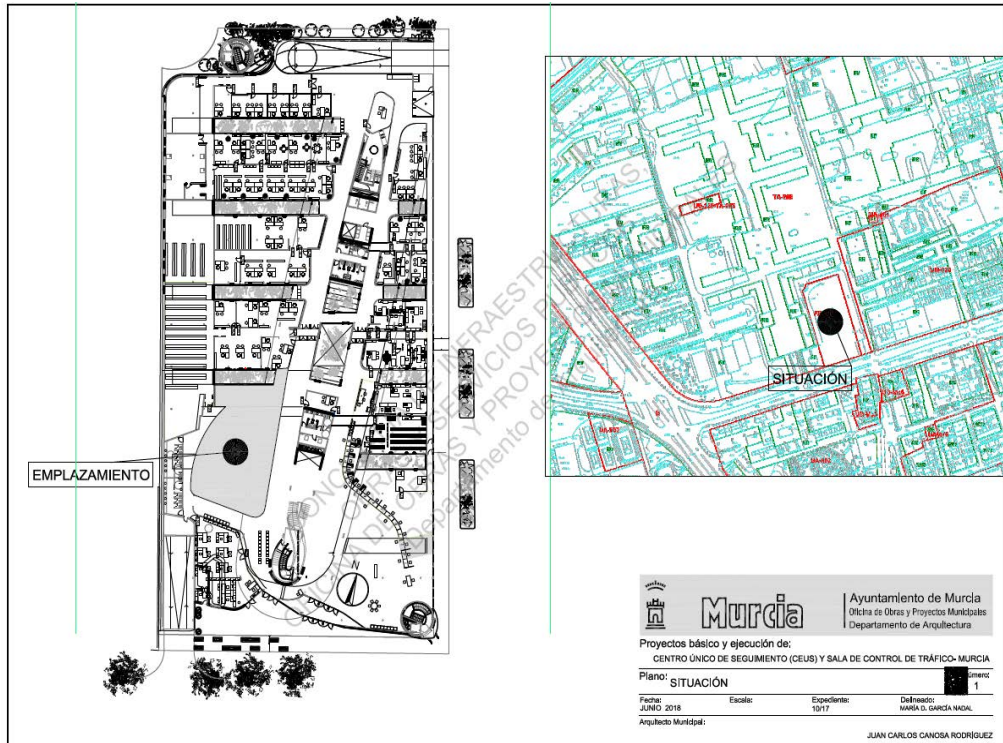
Plano de la planta del Edificio Abenarabi donde se ubica el Centro Único de Seguimiento CEUS.
